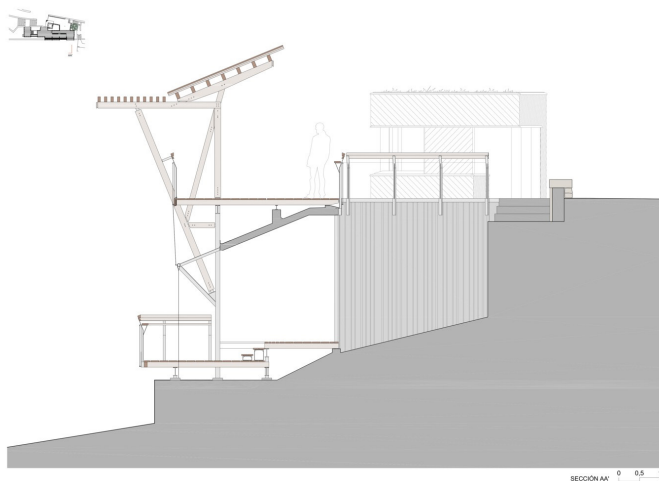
Sección constructiva con el detalle del muro de hormigón visto.
